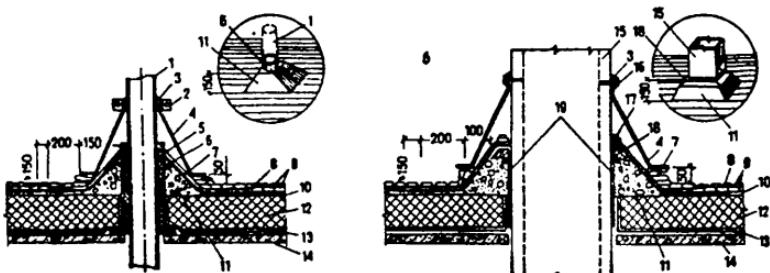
Детали примыкания рулонного гидроизоляционного ковра к элементам, прорезающим покрытие:
